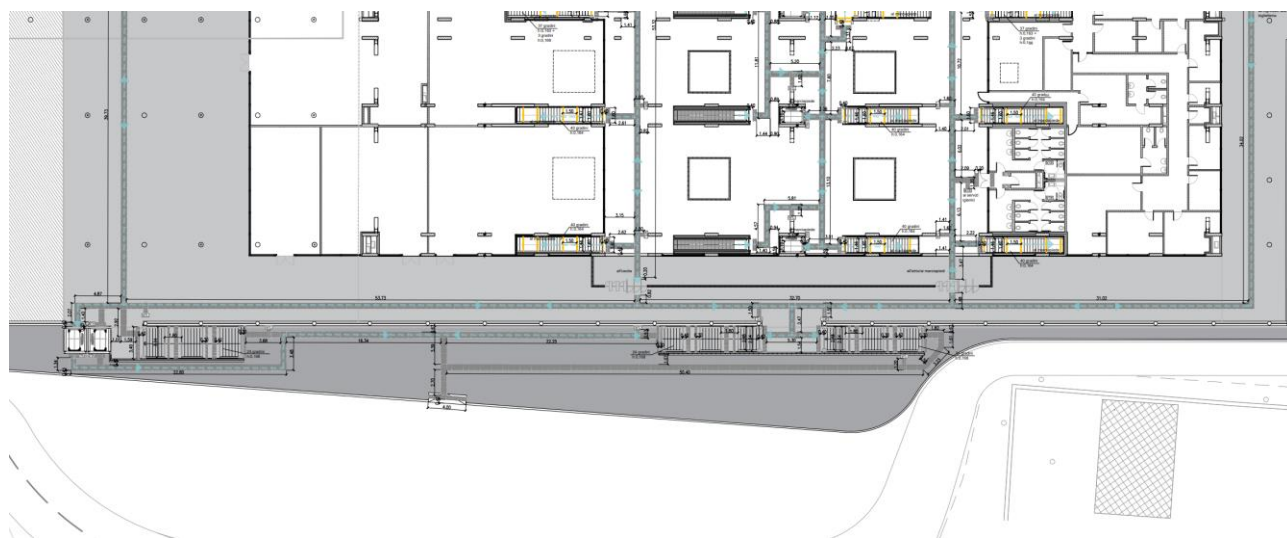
Planimetria di inquadramento del nuovo ingresso ovest.
